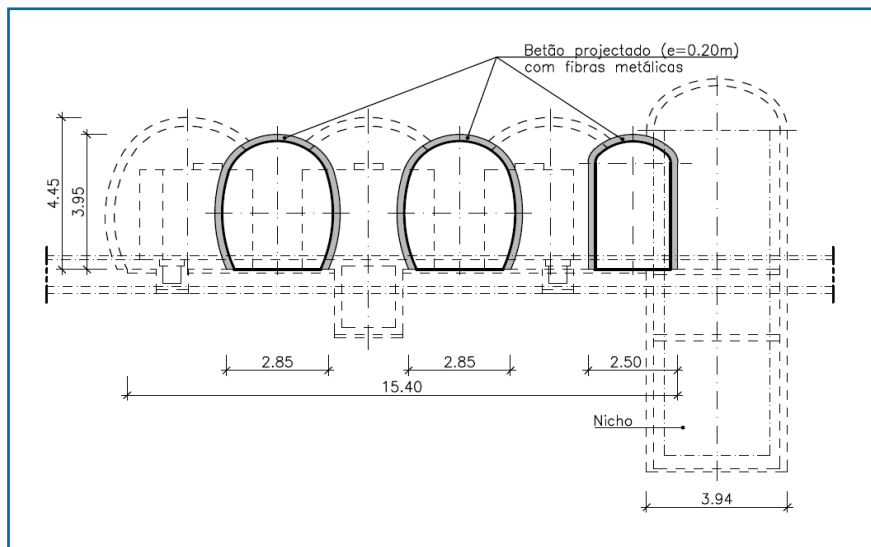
Secções transversais dos túneis para criação dos pilares de reforço
